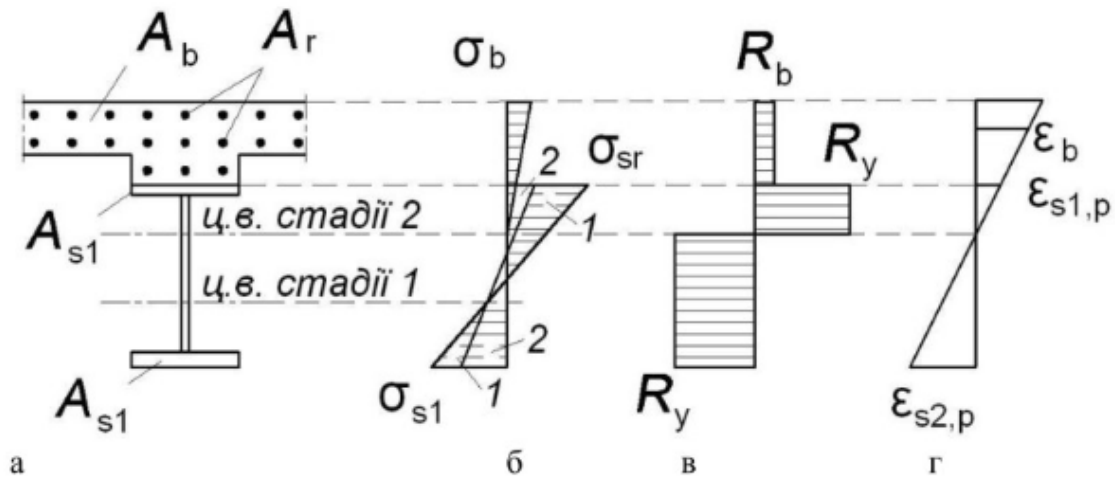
Епюри напружень у перерізі сталезалізобетонної балки:
